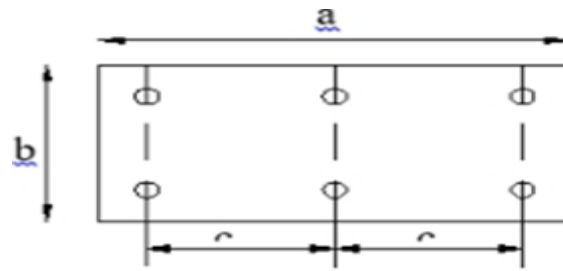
Espacement entre les armatures longitudinales d'un poteau.
